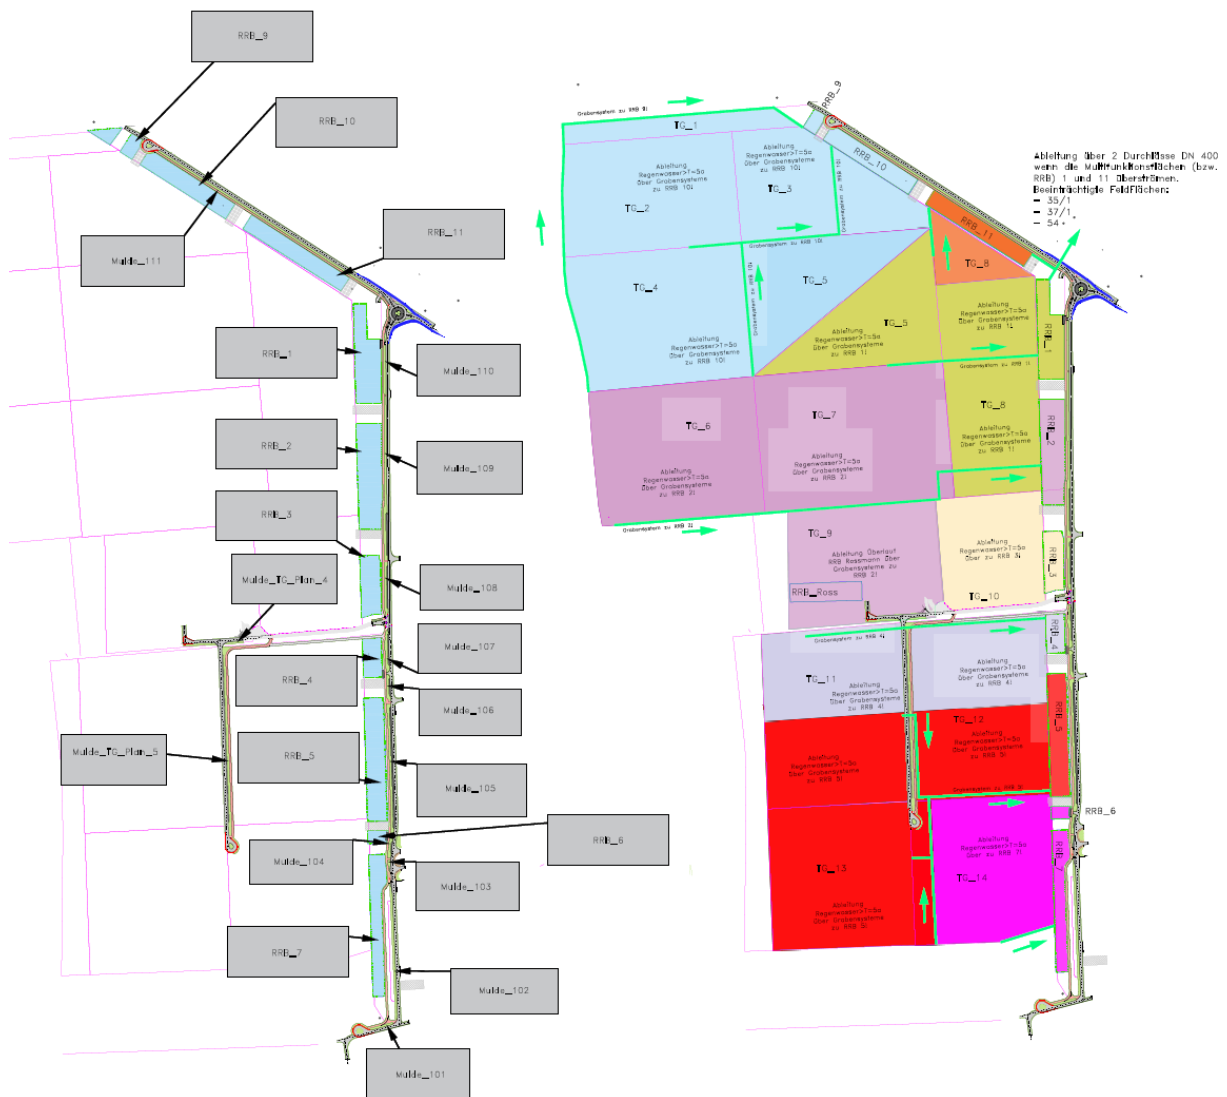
Lageplan der dezentralen Entwässerung © Fichtner Water & Transportation, 2024
